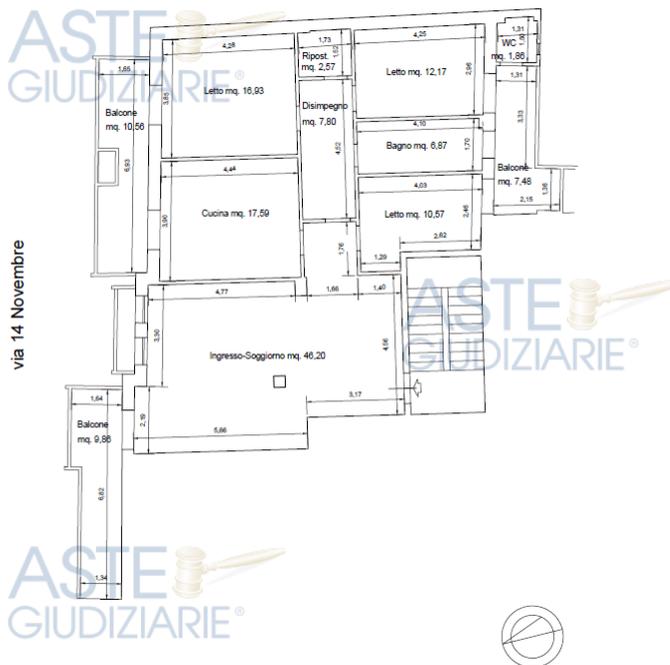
Planimetria rilevata del sub. 19 - secondo piano - non in scala
